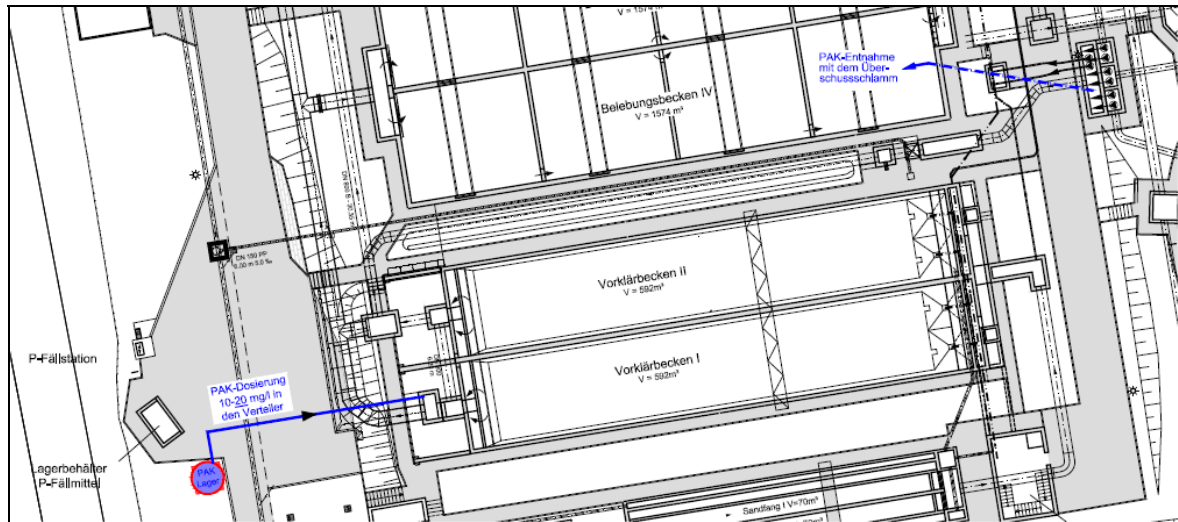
Lageplan KA Geseke - Variante 1.1 – Dosierstelle PAK im Zulauf zur Belebung
